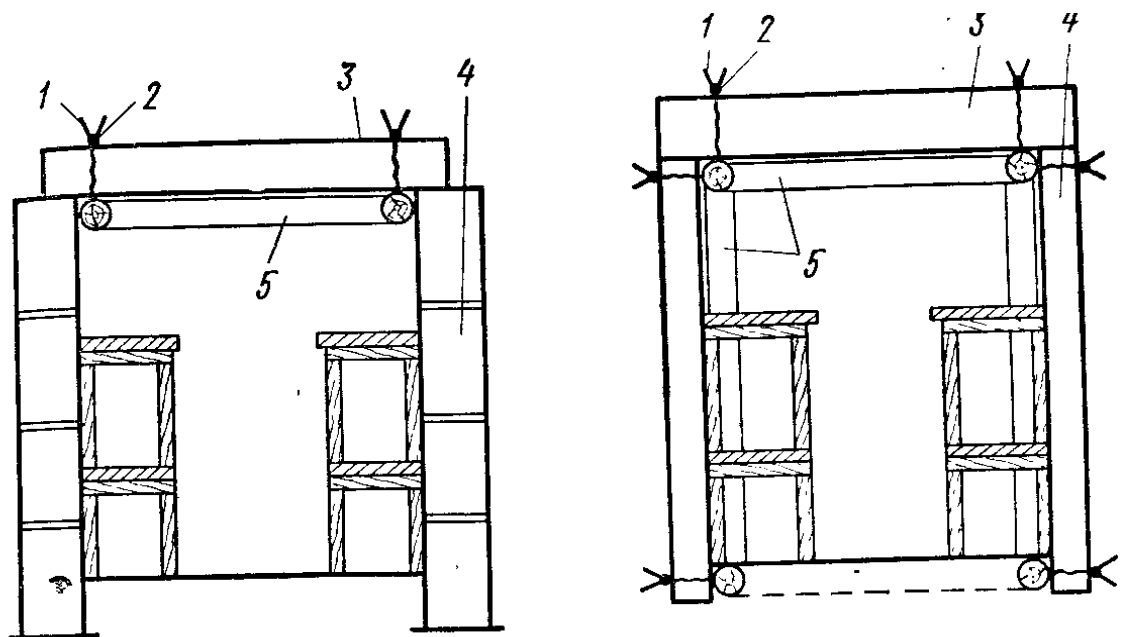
Поперечный разрез убежища, возводимого с использованием для устройства стен бетонных блоков, где
